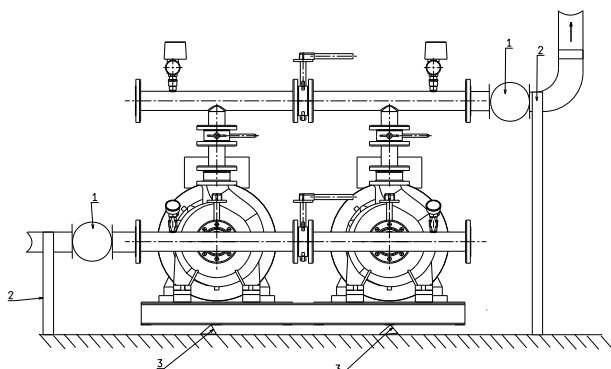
1 – Компенсаторы (упругие соединительные патрубки) для труб; 2 – Жесткие опоры для крепления труб; 3 – Виброизолирующие опоры
